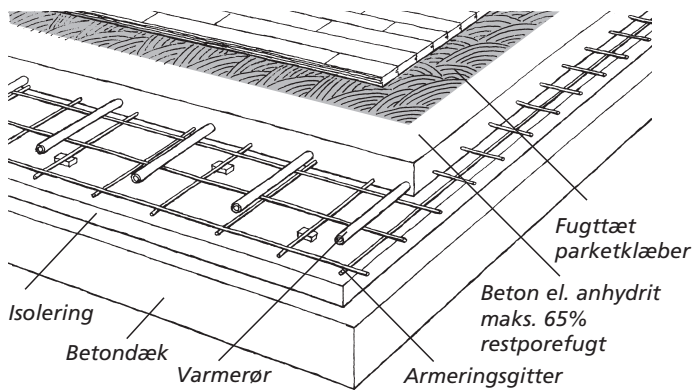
Betondæk med varmerør indstøbt i min. 70 mm beton som underlag for fuldklæbet gulv. Der skal anvendes en fugttæt parketklæber.
